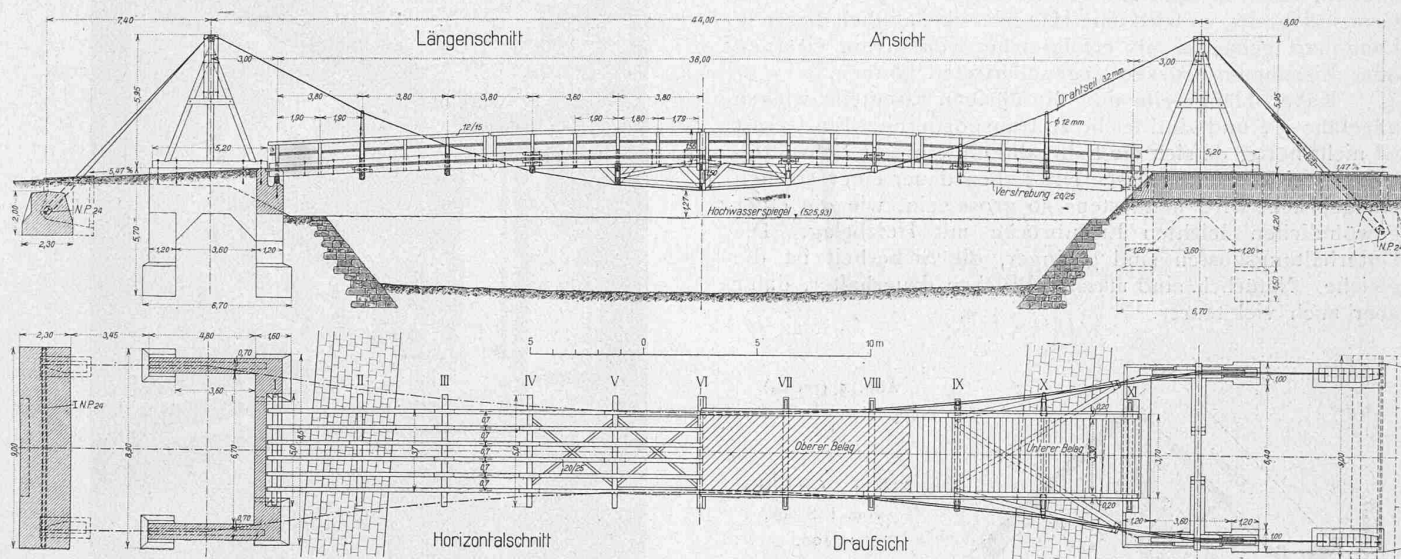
Ansicht, Grundriss und Längsschnitte der Drahtseil-Hängebrücke in Landquart. — 1 : 300
